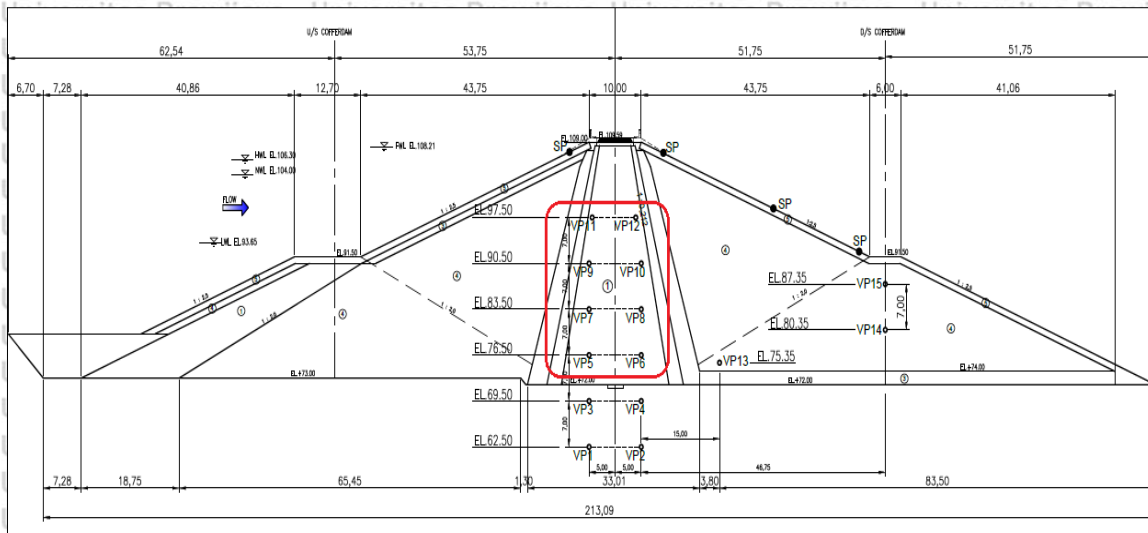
Potongan Melintang Instrumen *Vibrating Wire Piezometer* Pada Pondasi – MD.16 (STA 0+420)
